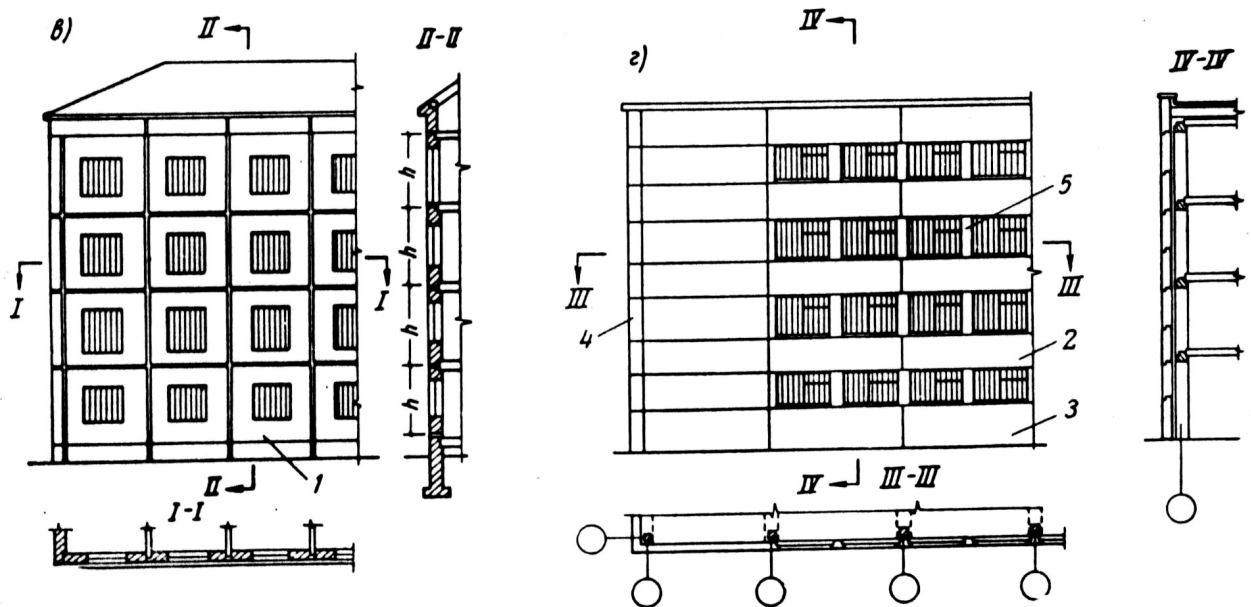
Примеры схем разрезки и компоновки панелей наружных стен
